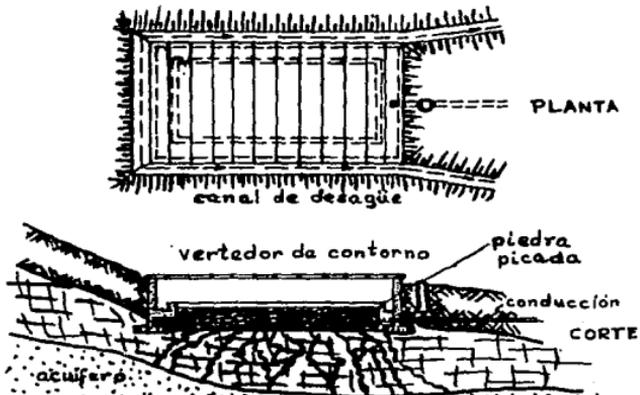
Dibujo esquemático de obras de captación directa de manantiales con afloramiento vertical.
